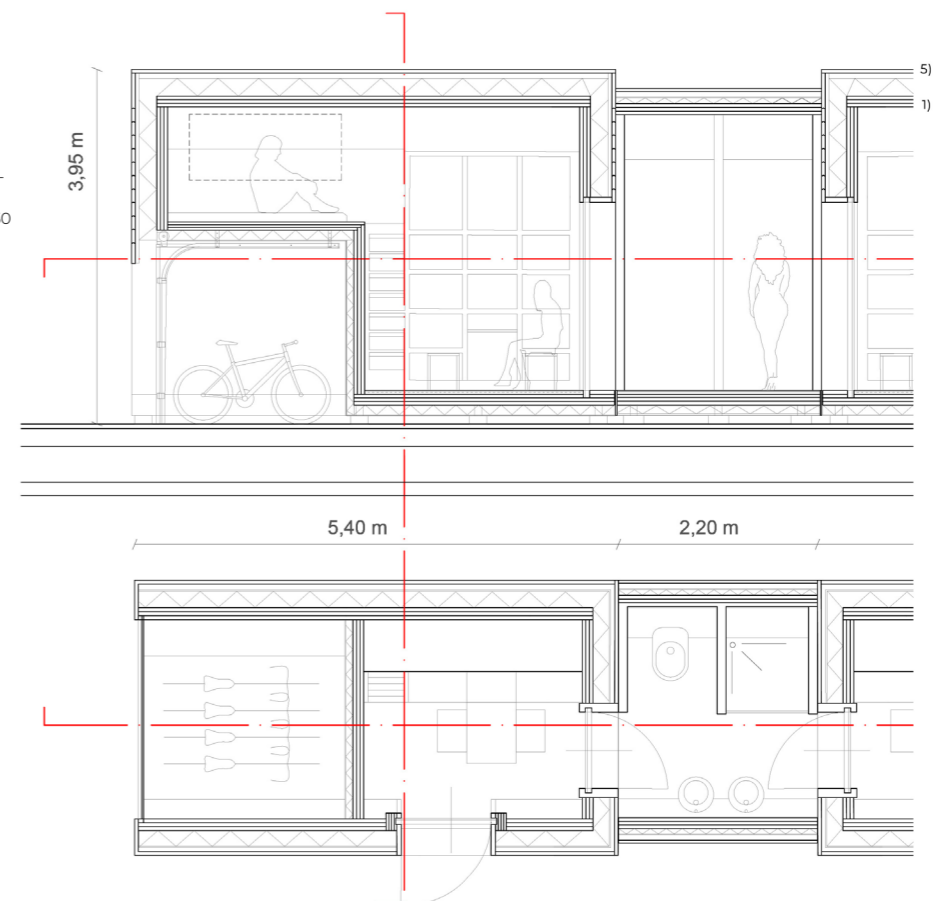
Pianta e sezioni del modulo abitativo da 2 posti con servizi condivisi
